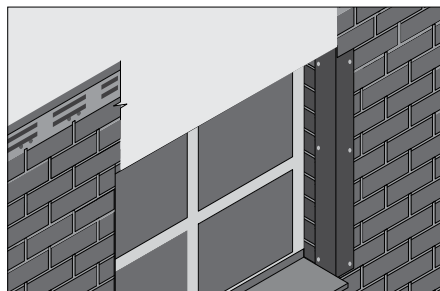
Монтаж бокового наличника (верхний край заходит под фасадную плитку)
